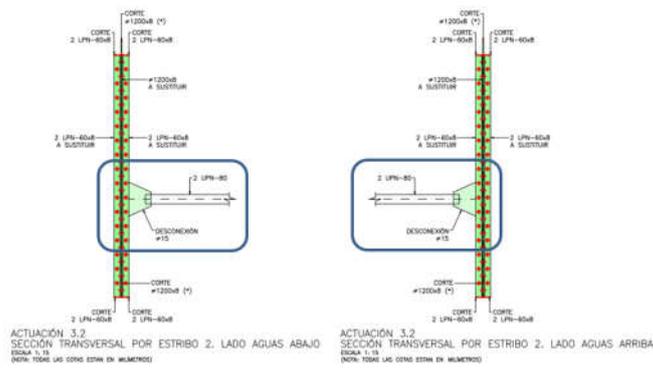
Nudo intermedio mamparo estribo 2. Desconexión de cartela arriostramiento transversal.
